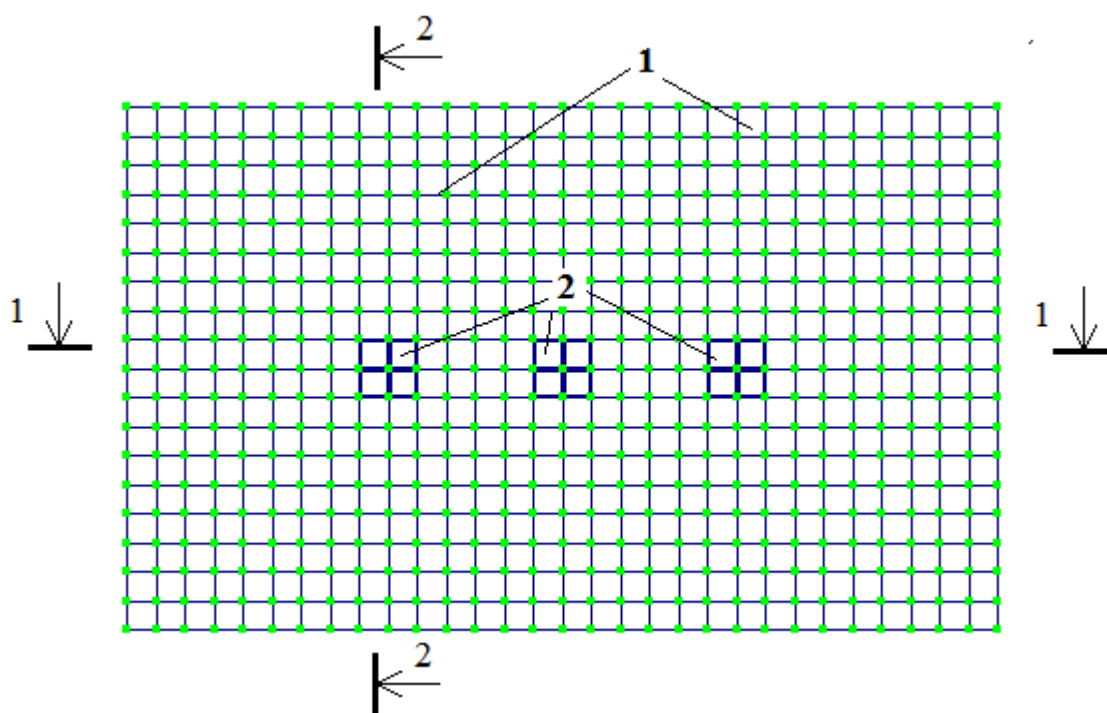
Розрахункова схема. Вихідний стан. План. 1 – основа; 2 – фундаменти; 3 – рамна конструкція
